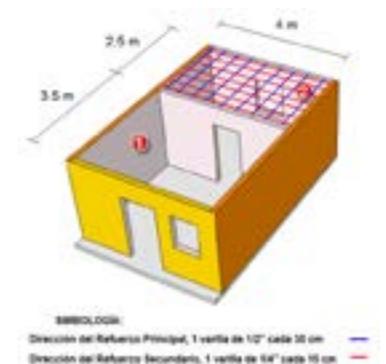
Dirección del Refuerzo Principal y Refuerzo Secundario
